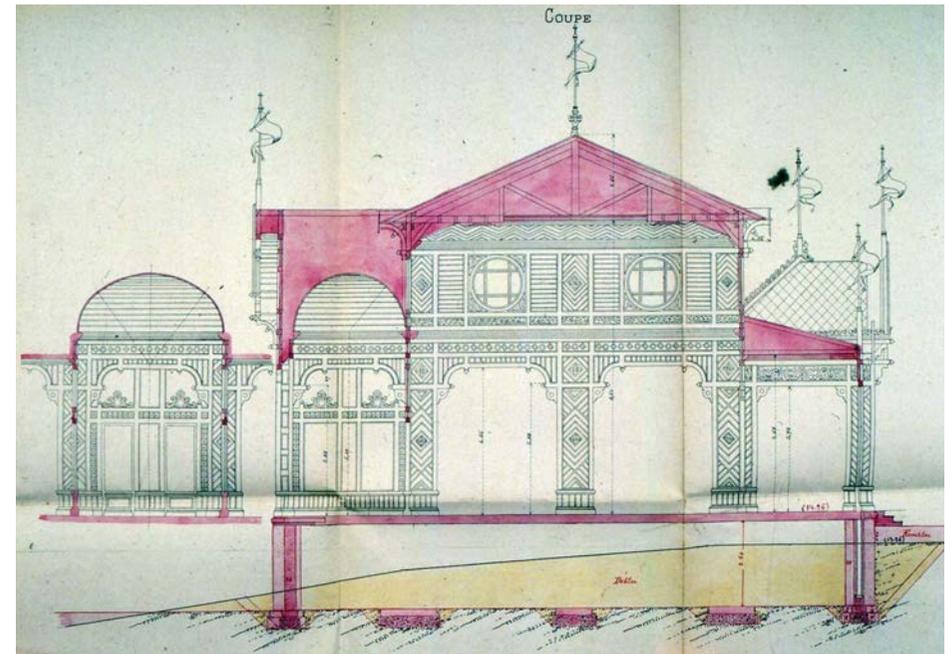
LELON, 1890, Plan de construction du casino, Archives en ligen de la Somme, 99 O 2594
